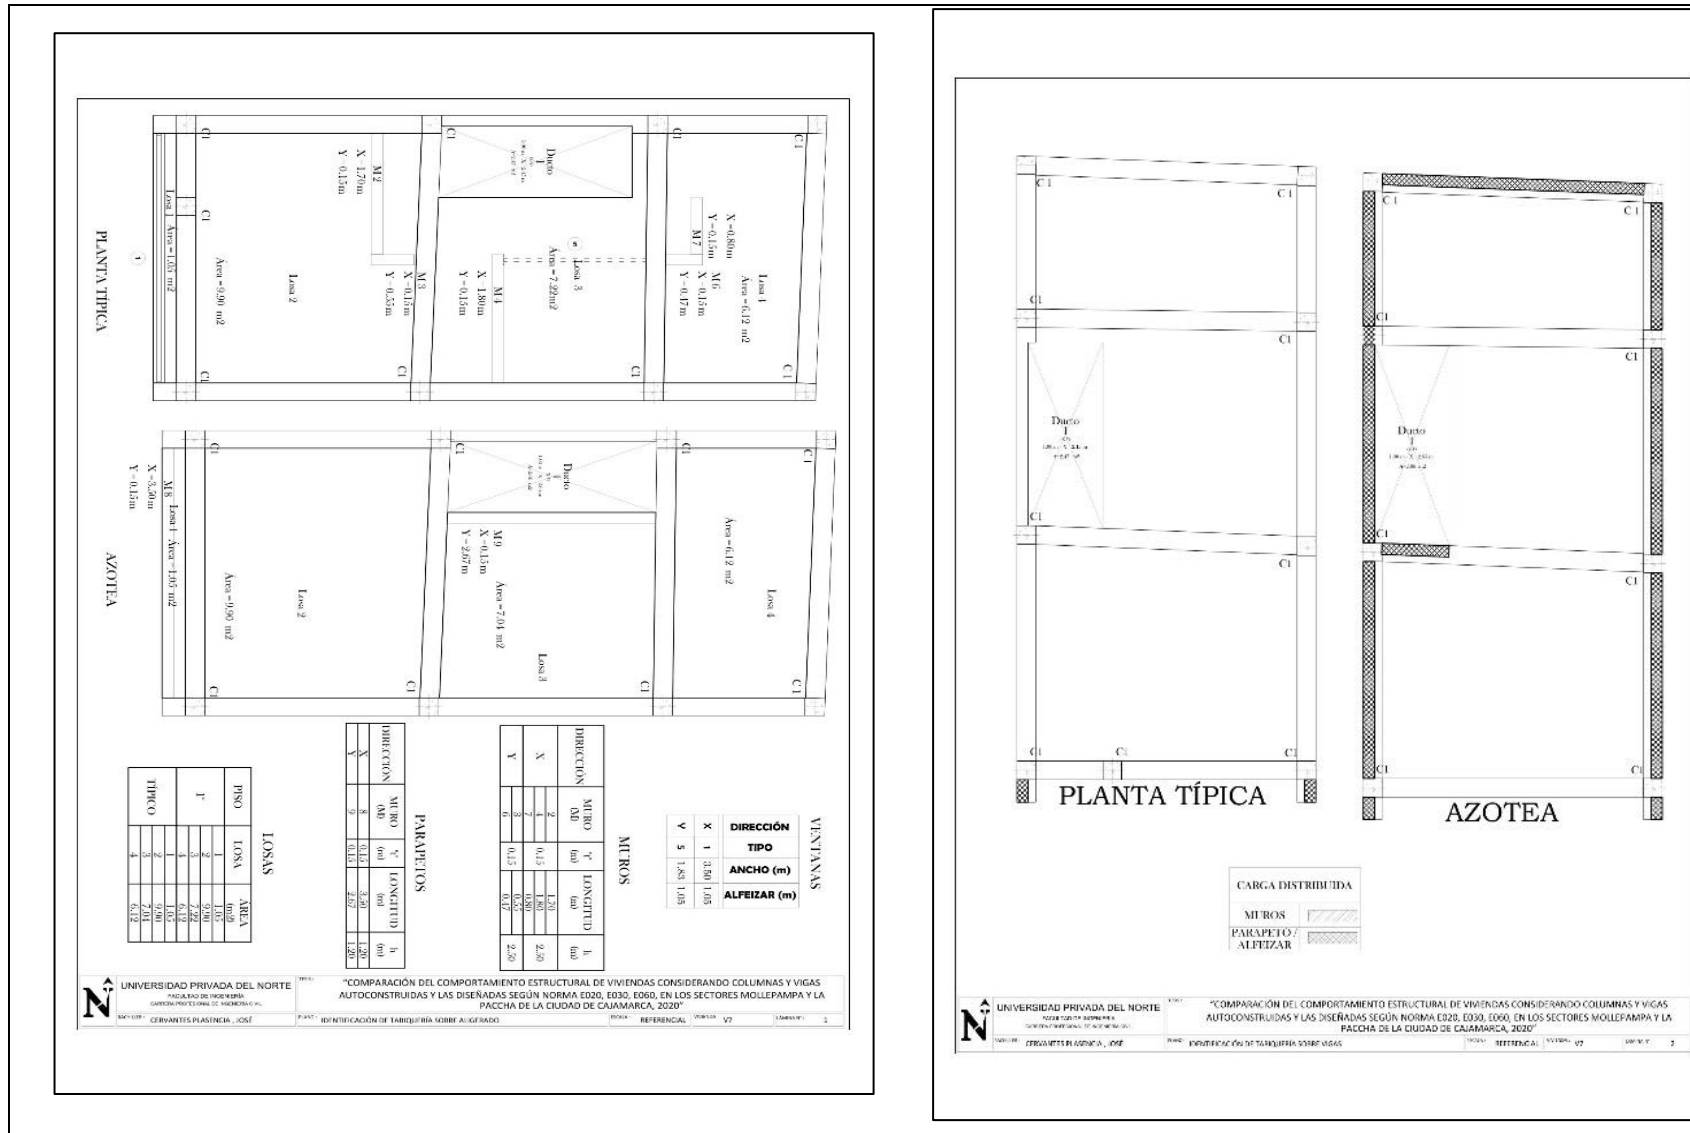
Tabiquería sobre losa aligerada y vigas vivienda 7
